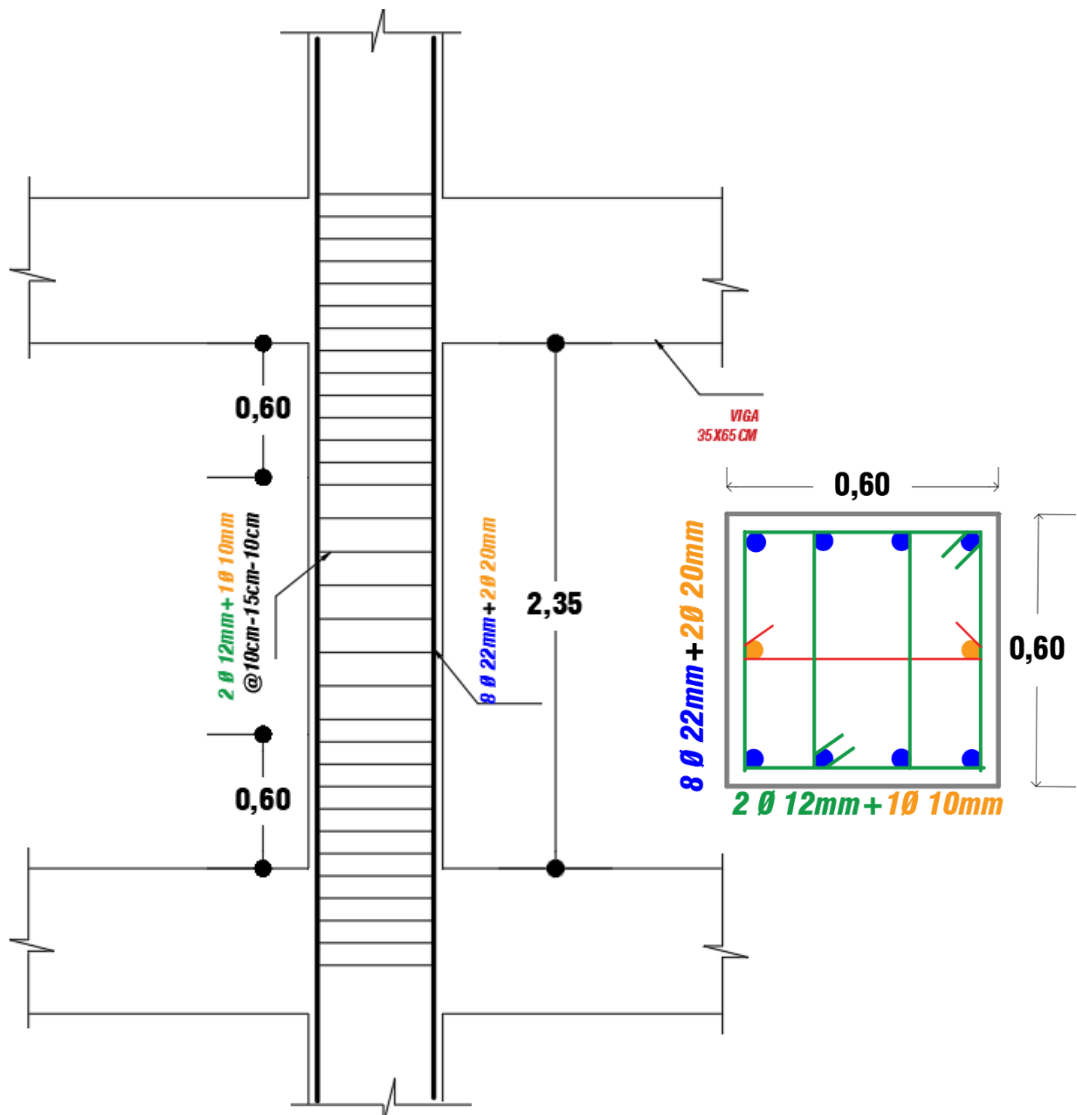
Detalle de Acero transversal y longitudinal de la columna del sistema $R=8$
